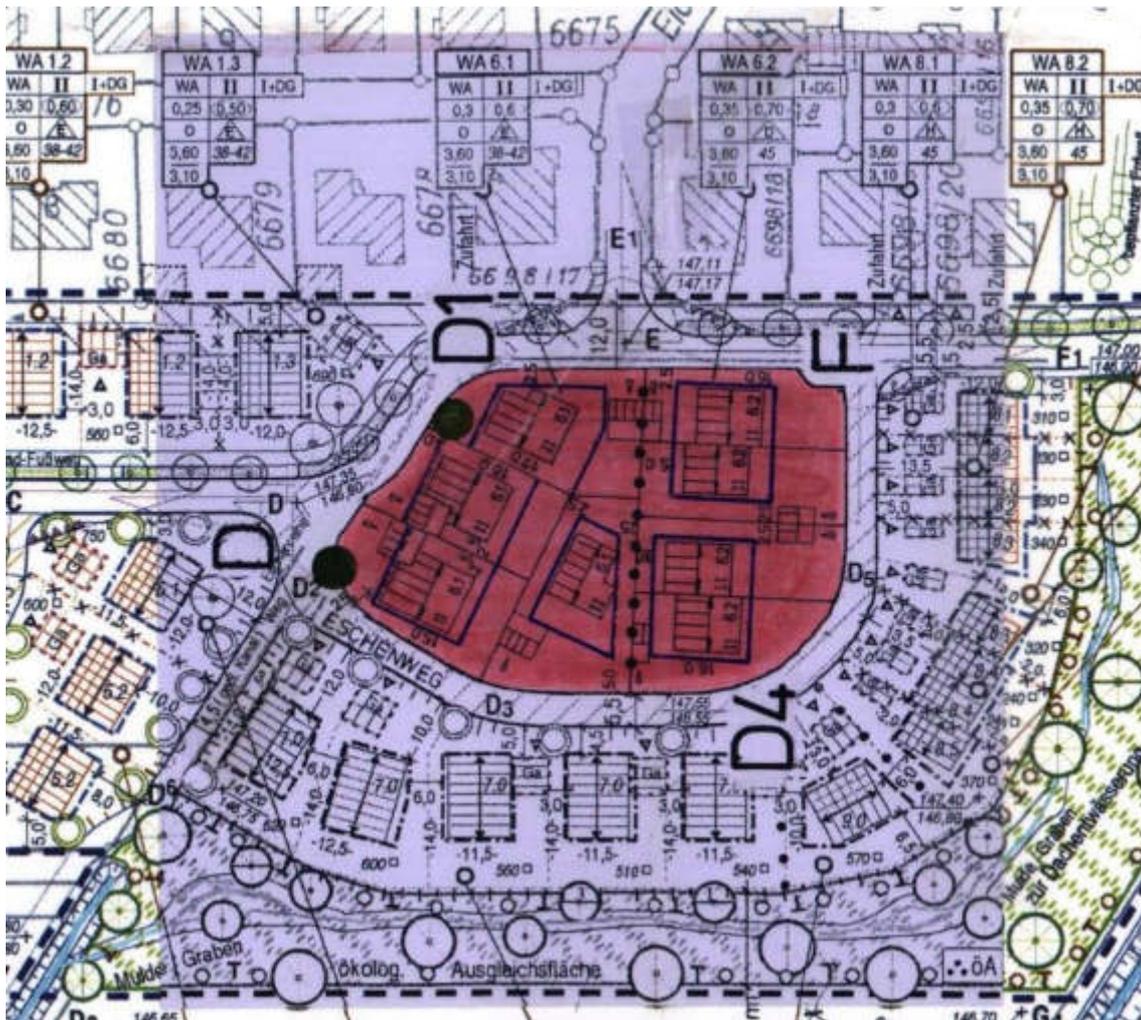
Ausschnitt aus Bebauungsplan Hanfbündt-West (S-Kurve und Einmündung Eschenweg)
